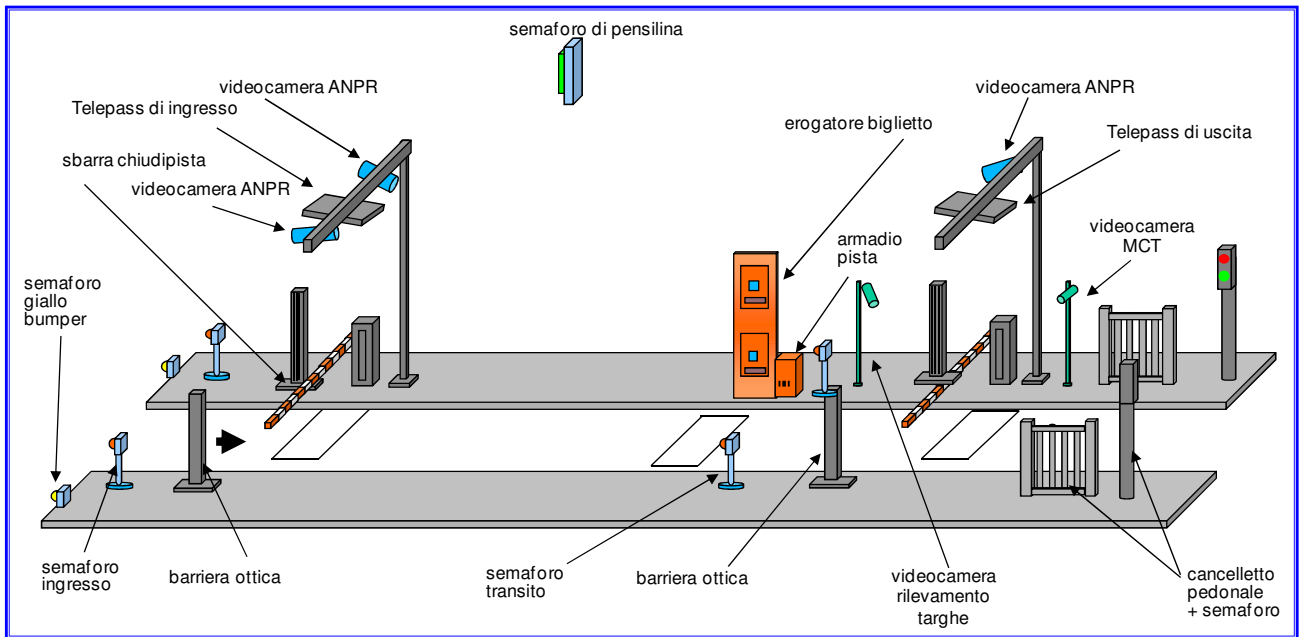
Schema della pista con emissione biglietto e Video + Telepass
